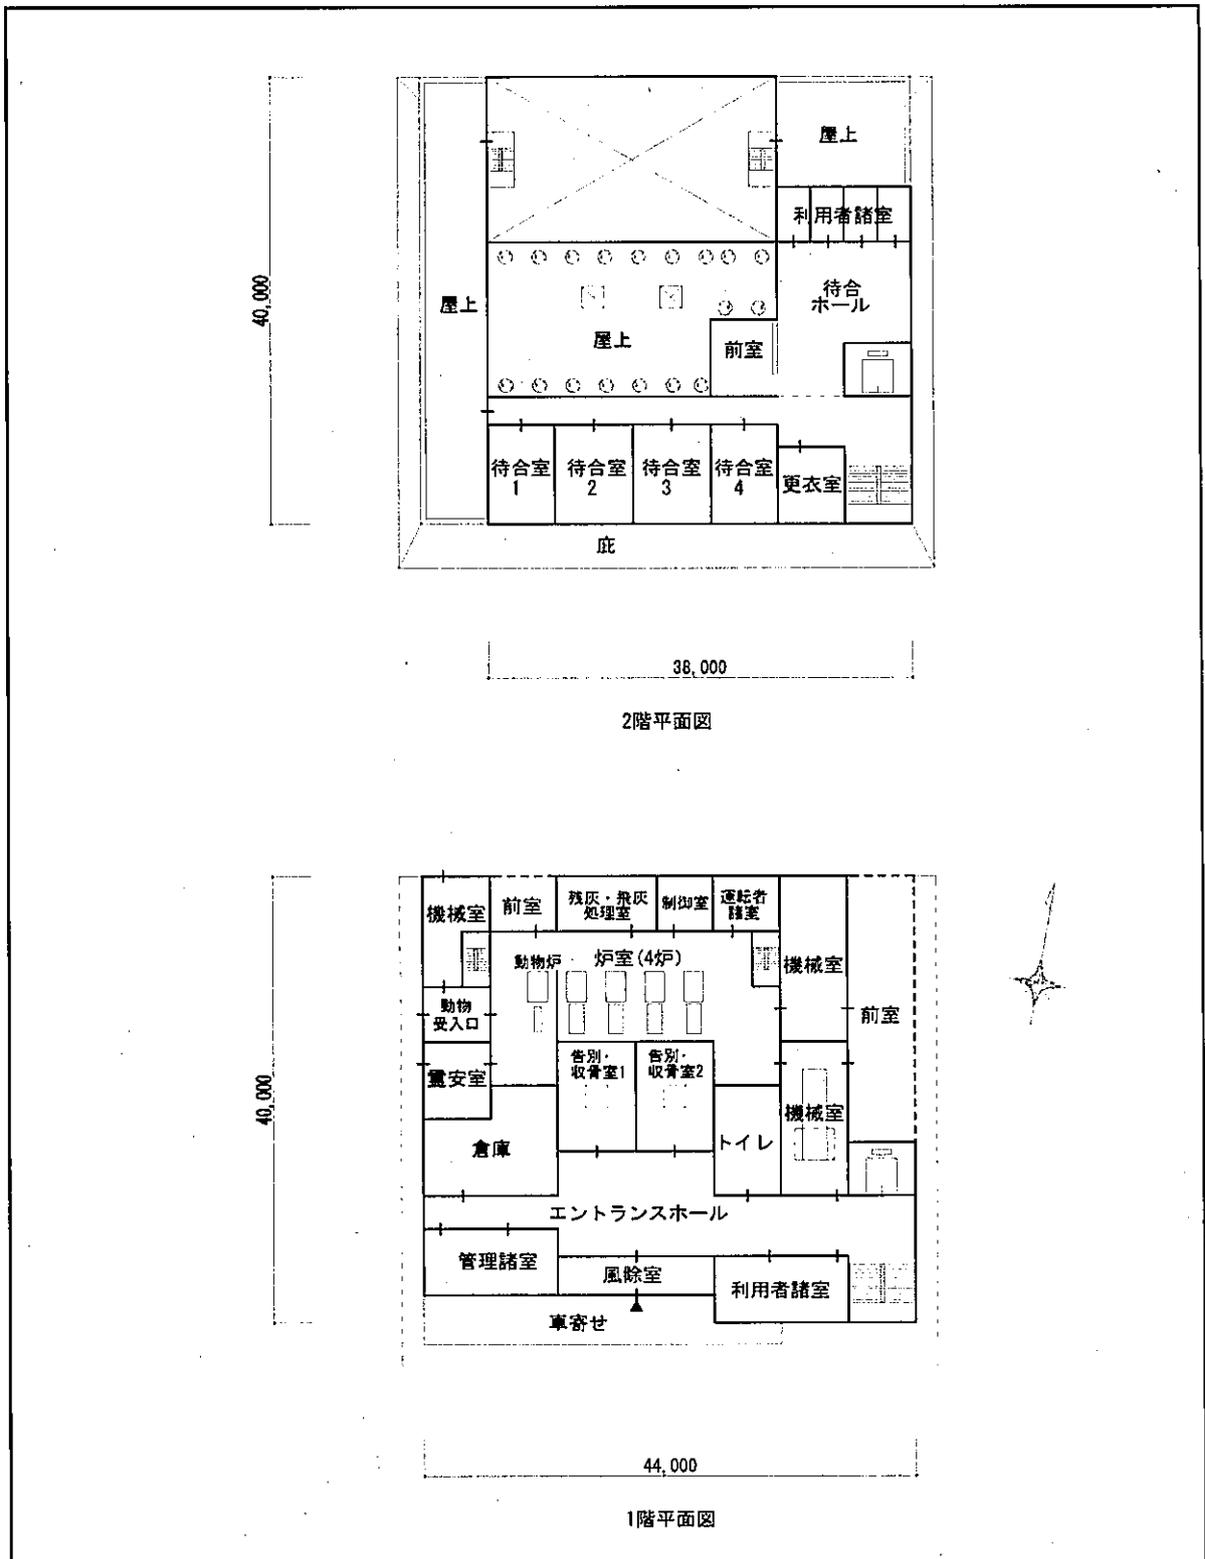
栗東市単独整備(2.5 件/基・日) モデルプラン平面図
